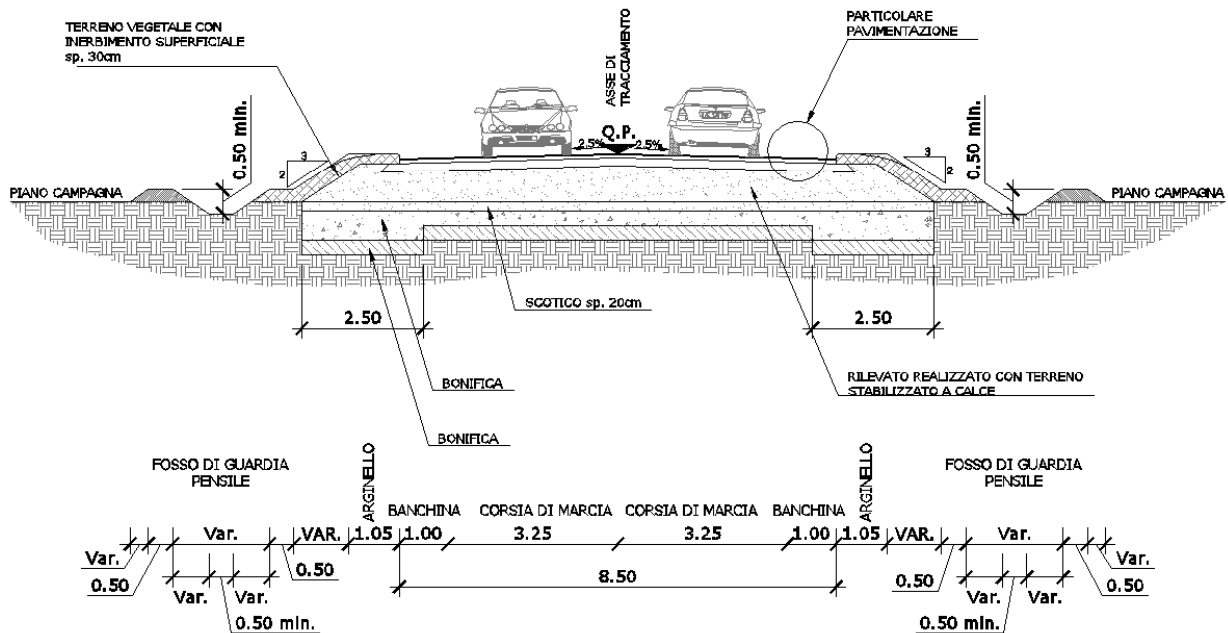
Esempio di sezione tipo F2 in rettifilo
